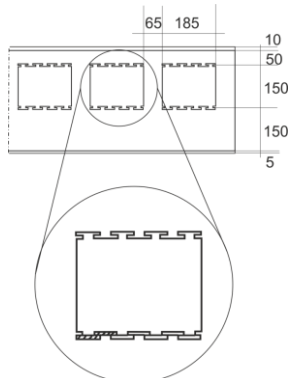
Schemat obliczeniowy przekroju ściany w przekroju A-A (wszystkie wymiary w mm)
